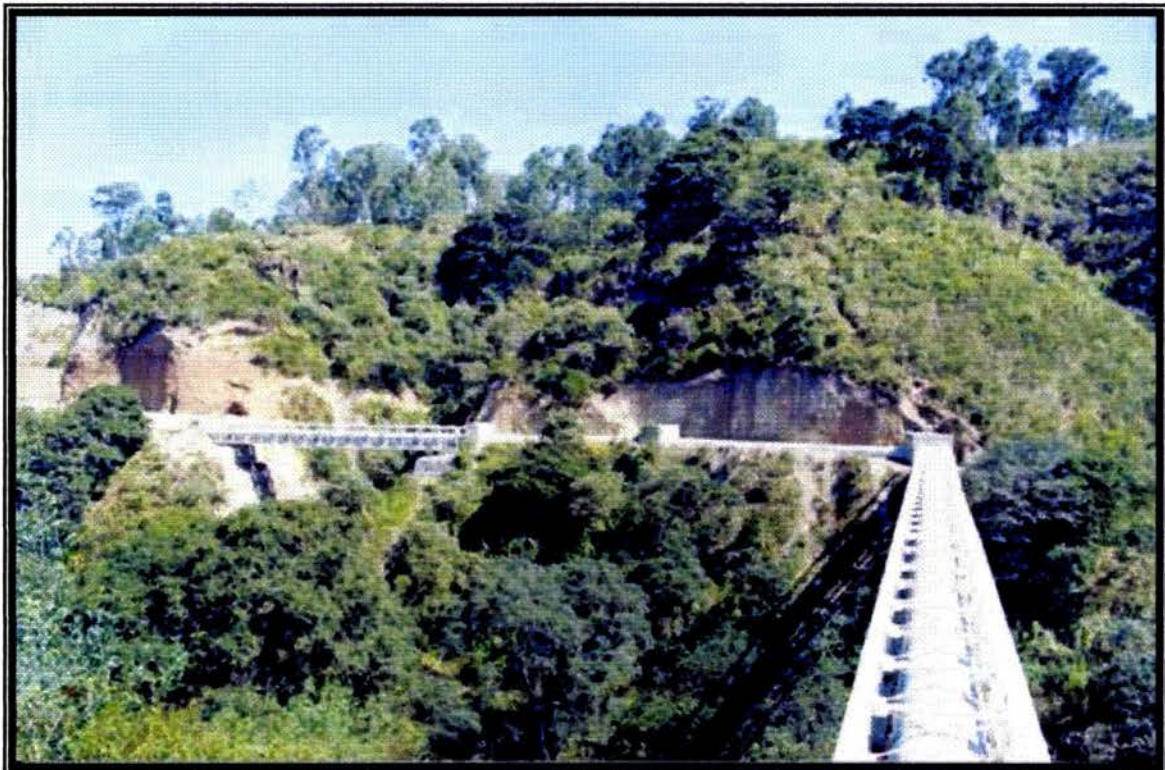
VISTA DESDE EL PUENTE No. 1, AL FONDO, EL PUENTE No. 2
